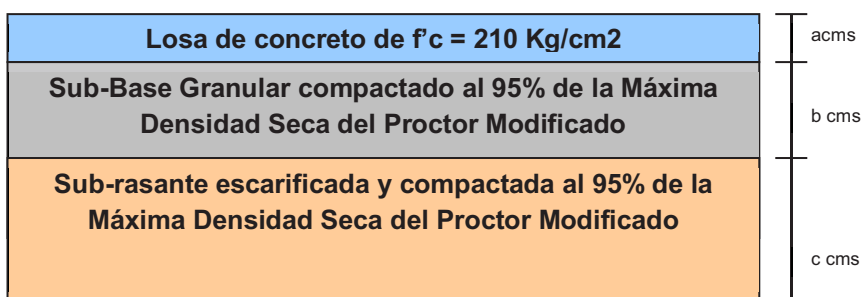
Esquema Estructural de Pavimento de Concreto.
